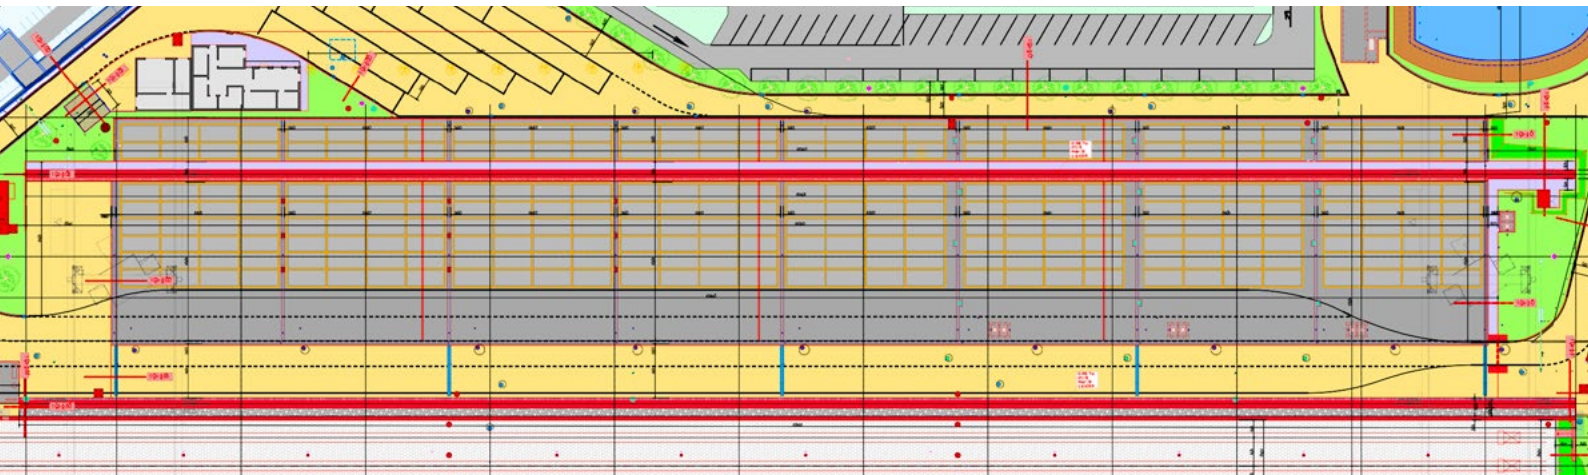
plan de la plateforme intermodale (en gris dalle en béton armé)
